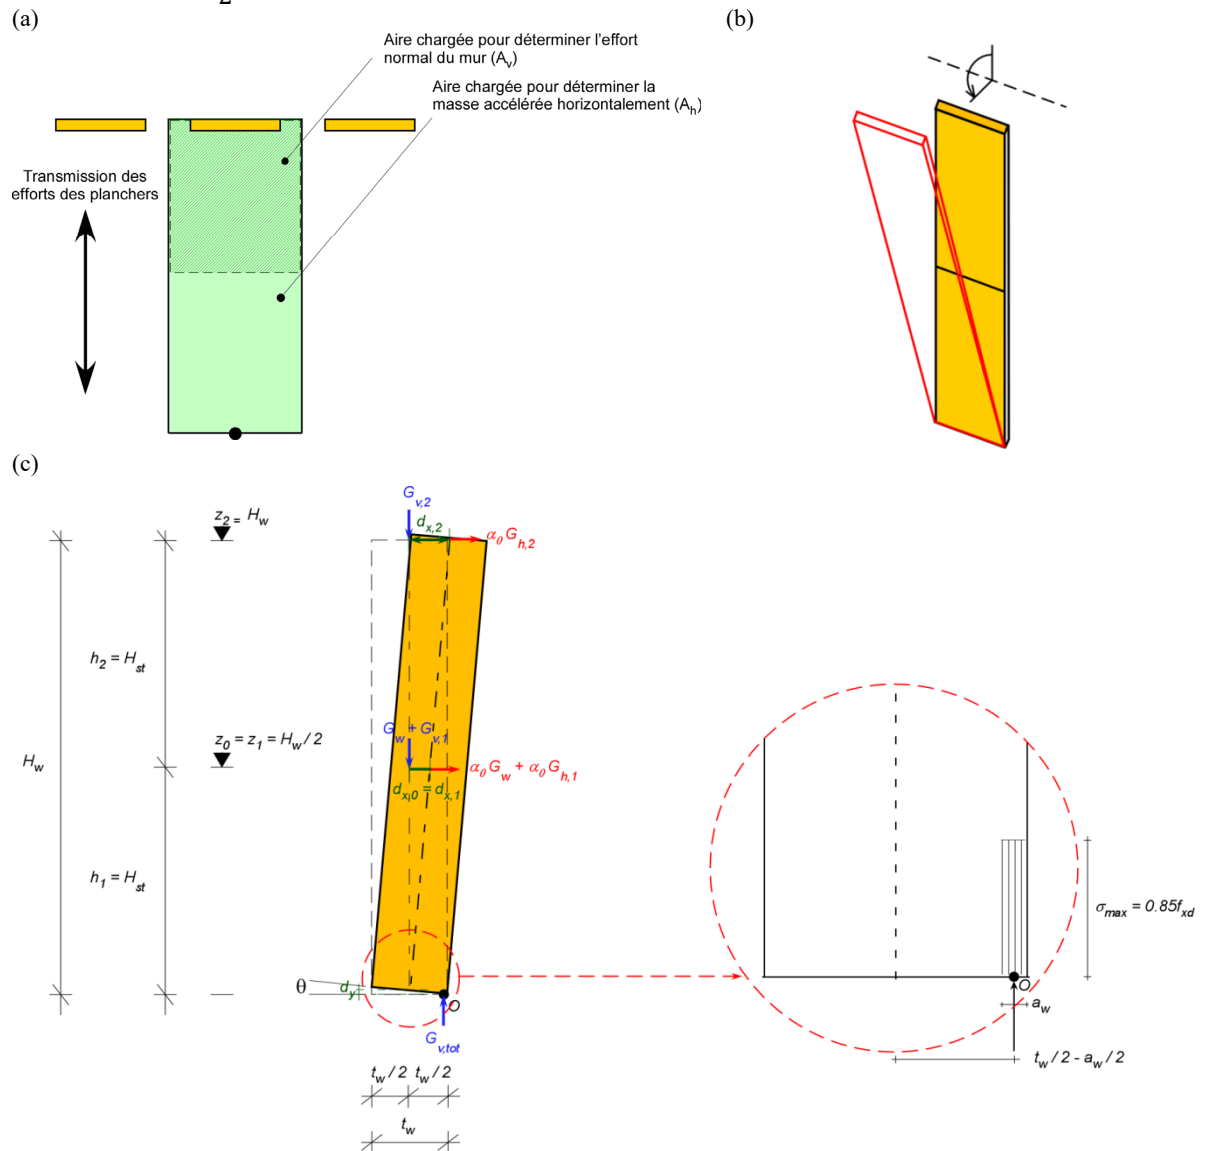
(a) Vue en plan, (b) Vue en coupe et (c) Notations et déformée de la poutre console.
